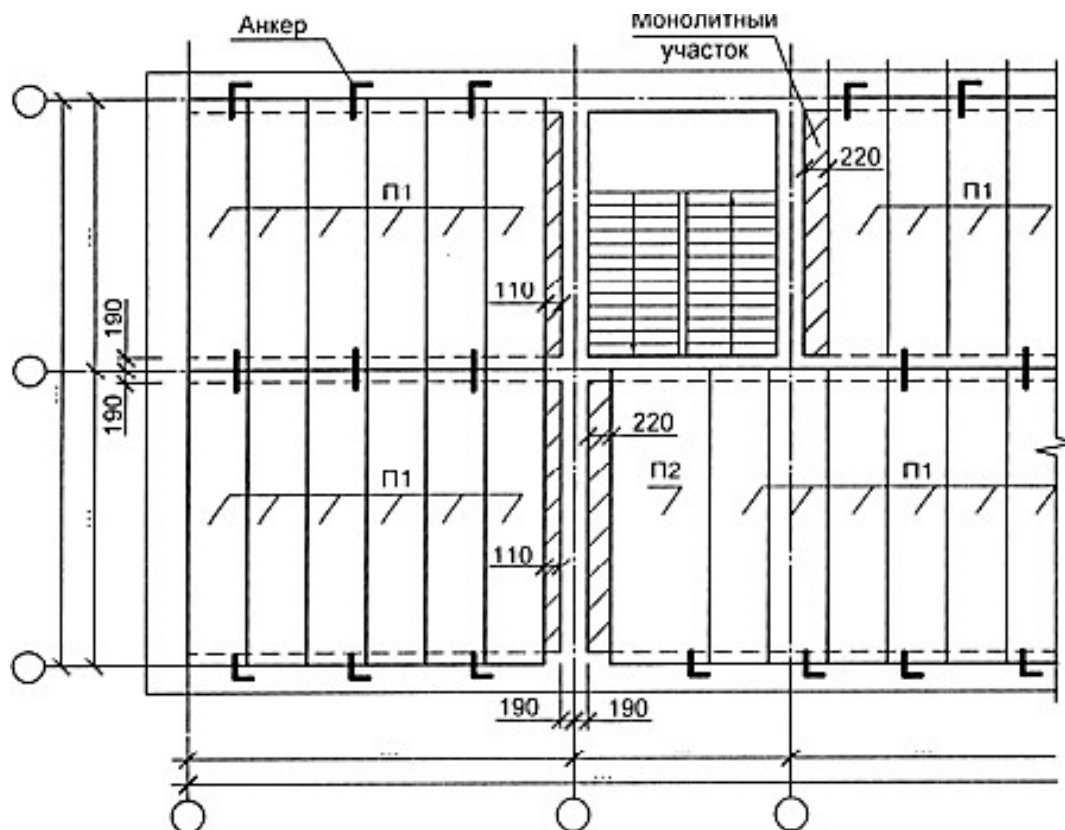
Фрагмент плана перекрытий при продольно-стеновой конструктивной системе
